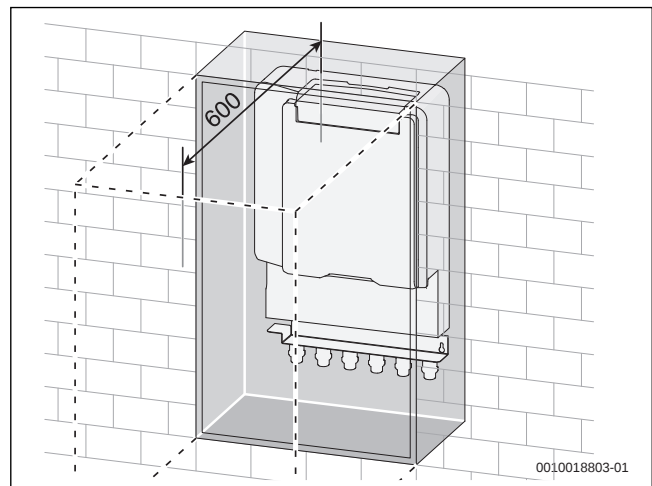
Mindestabstände für Montage und Wartung – Unterputzinstallation/Unterputzkasten (Maße in mm)
